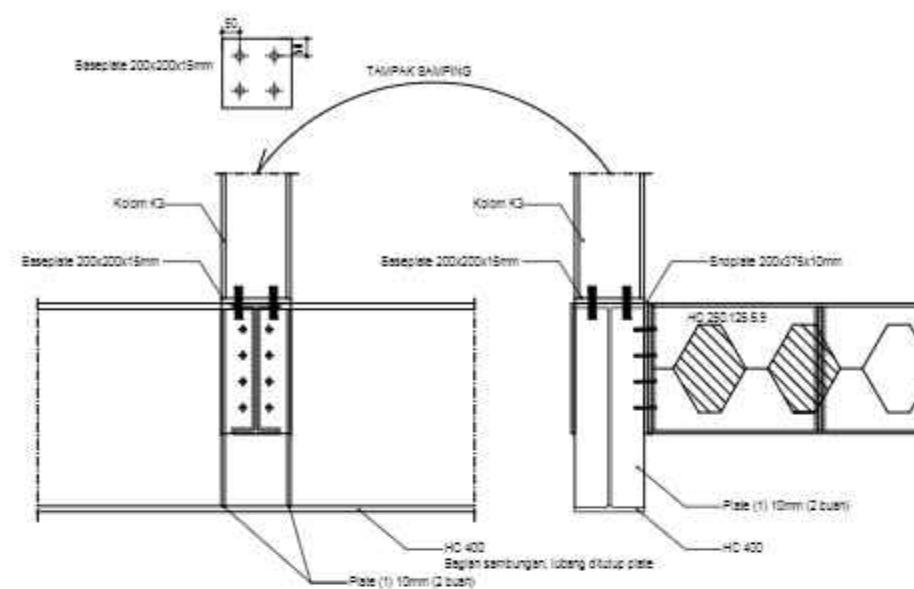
DETAIL HUB KOLOM K2 DUDUK DI BALOK RC 400 (1)
